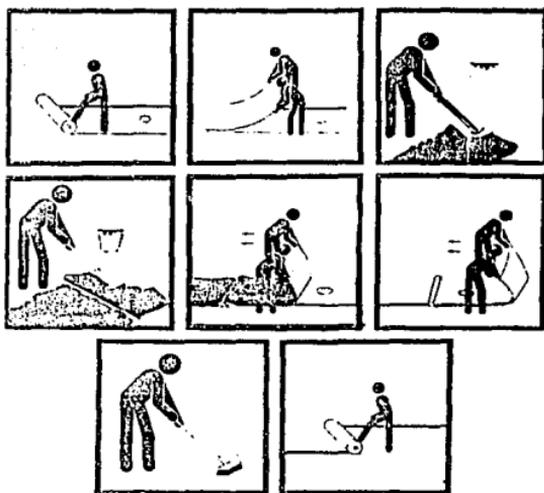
Impermeabilizante prefabricado. Aplicación con adhesivo
